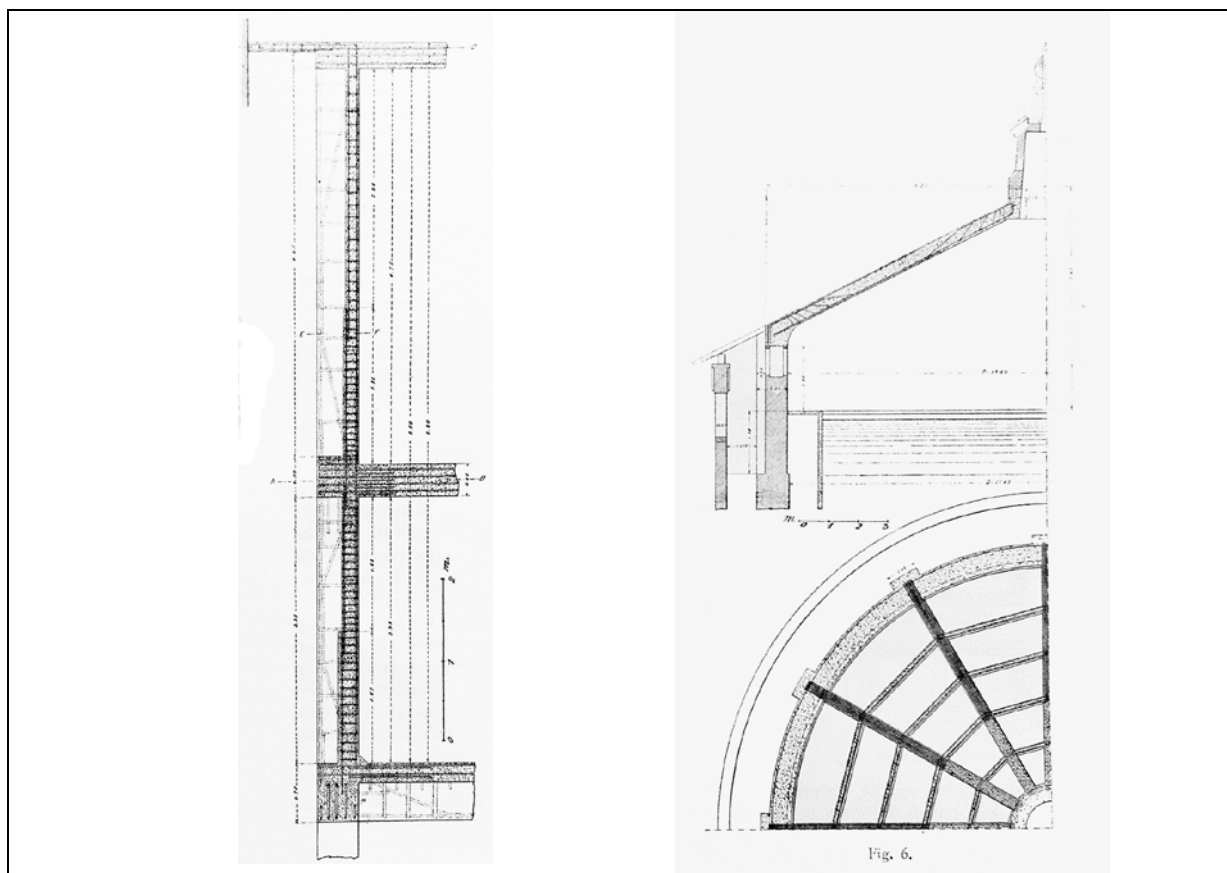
e 3: Struttura in c.a. sistema Hennebique di zone della parete verticale e della copertura a doppia soletta ("Il Cemento", apr.-mag. 1905, pp. 453 e 455)
